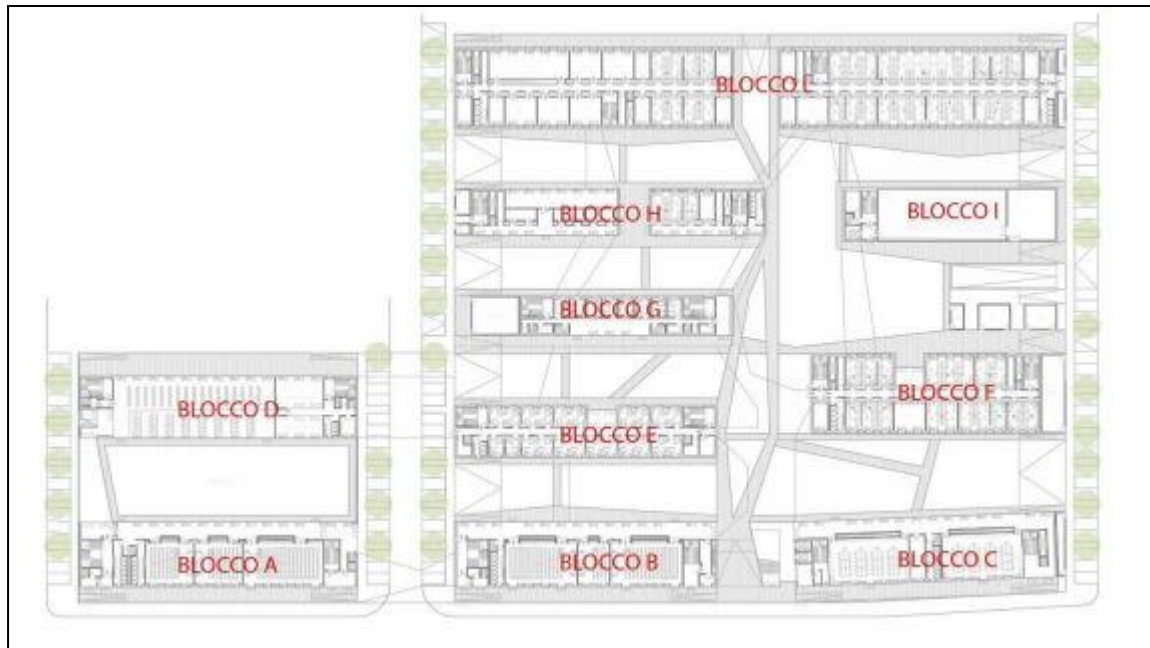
Planimetria con indicazione dei corpi di fabbrica
